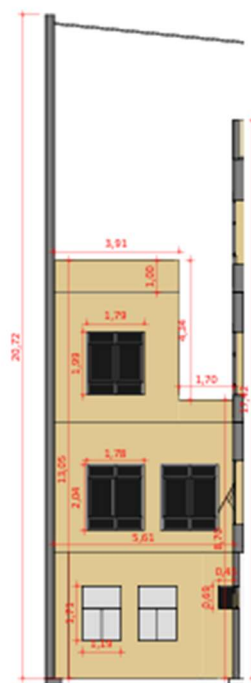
Elevação - Fachada Lateral Esquerda - Vista Leste
